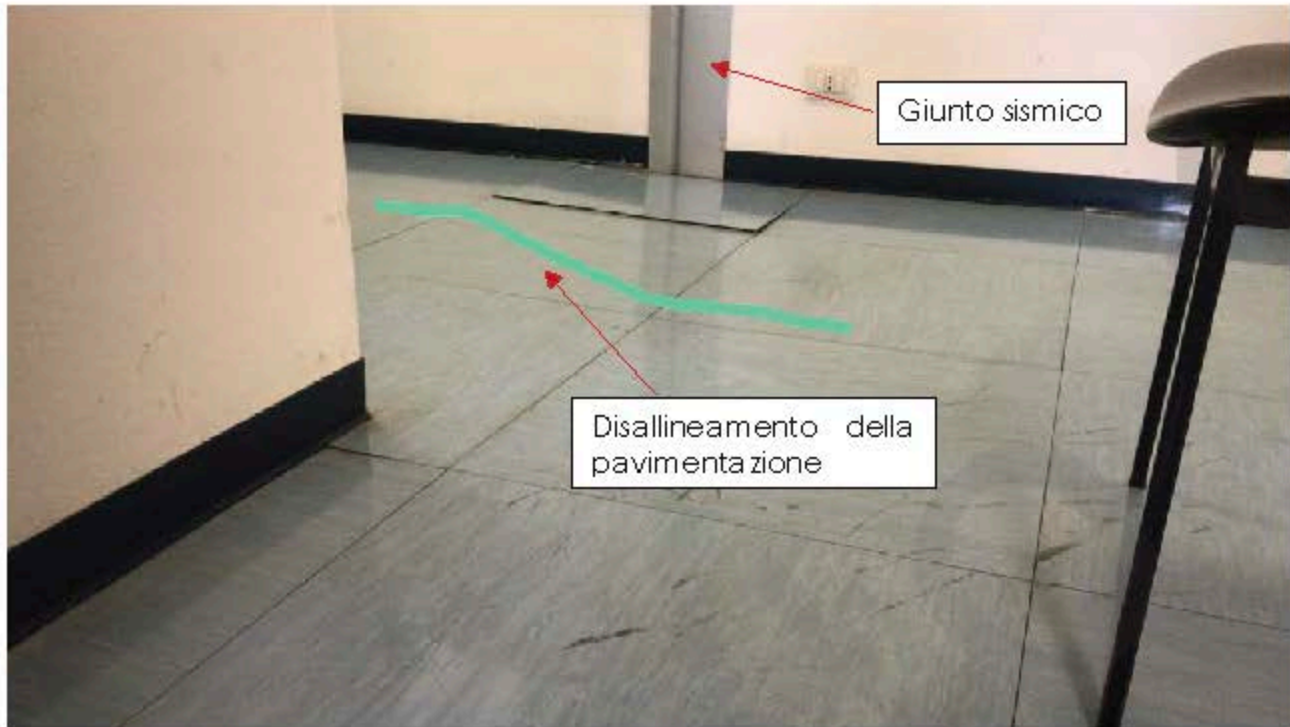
Quadro fessurativo - disallineamento pavimentazione
